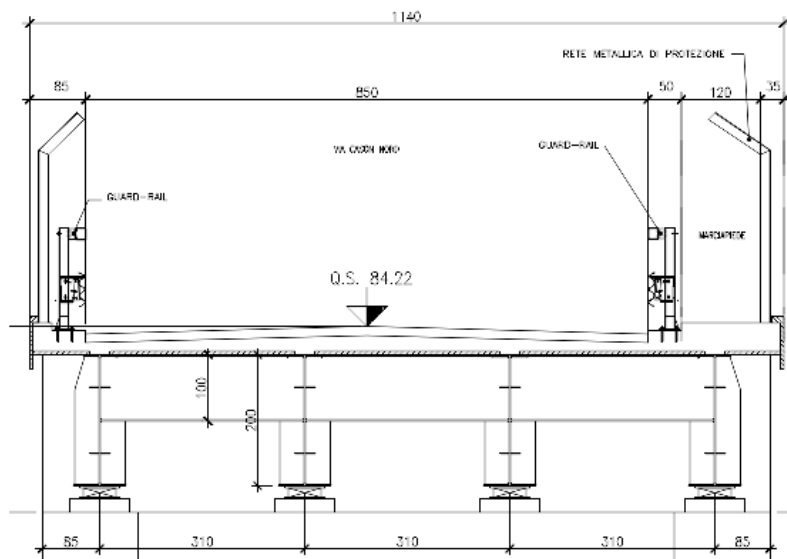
IV02 Cavalcavia Tangenziale Ovest – Pianta impalcato
